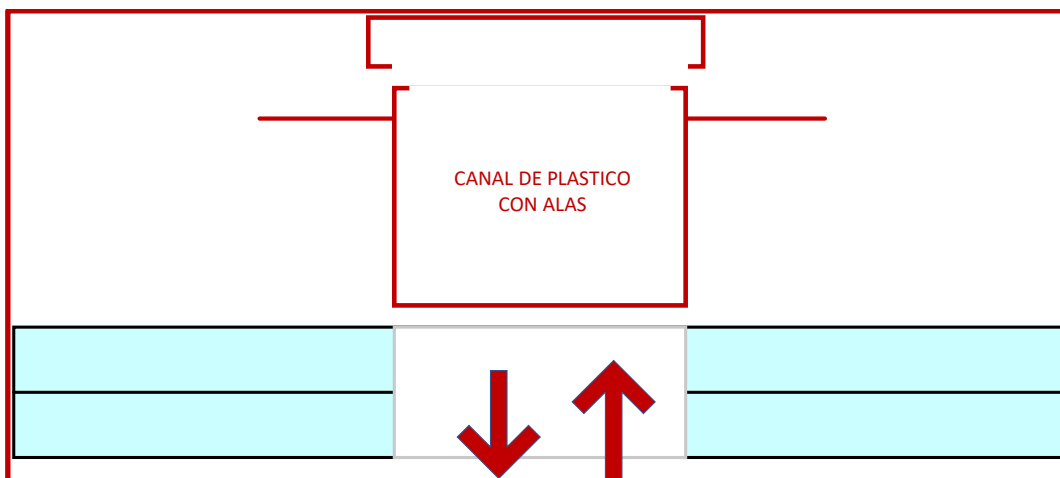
Canal constructivamente pensada para enrasar. con alas que disimulan las posibles mellas sobre el pladur. La canal debería sujetarse por el fondo, sobre el pladur del otro lado.
